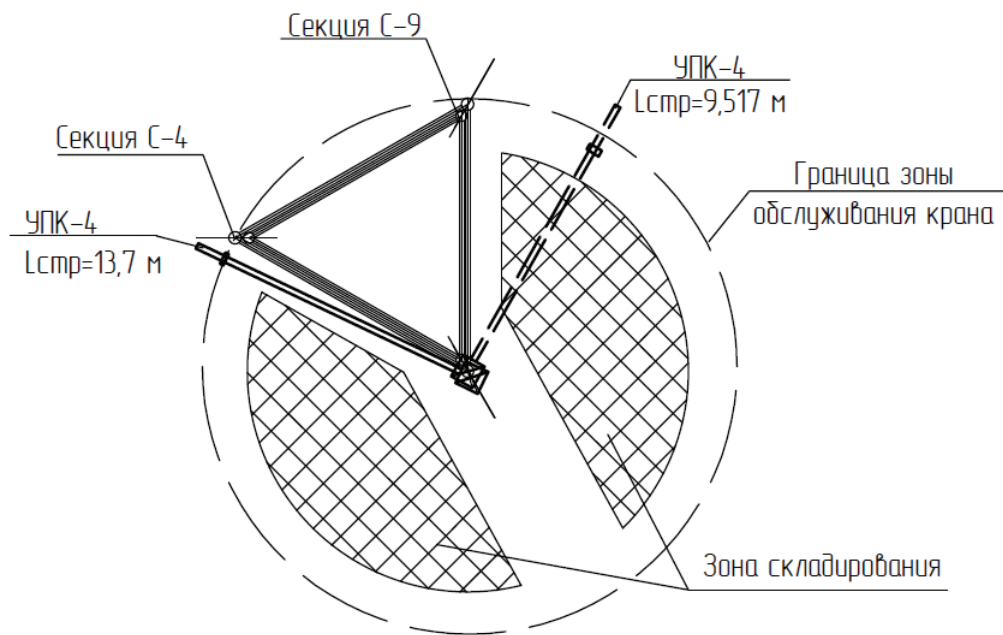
Расположение в плане монтажного крана УПК-4
